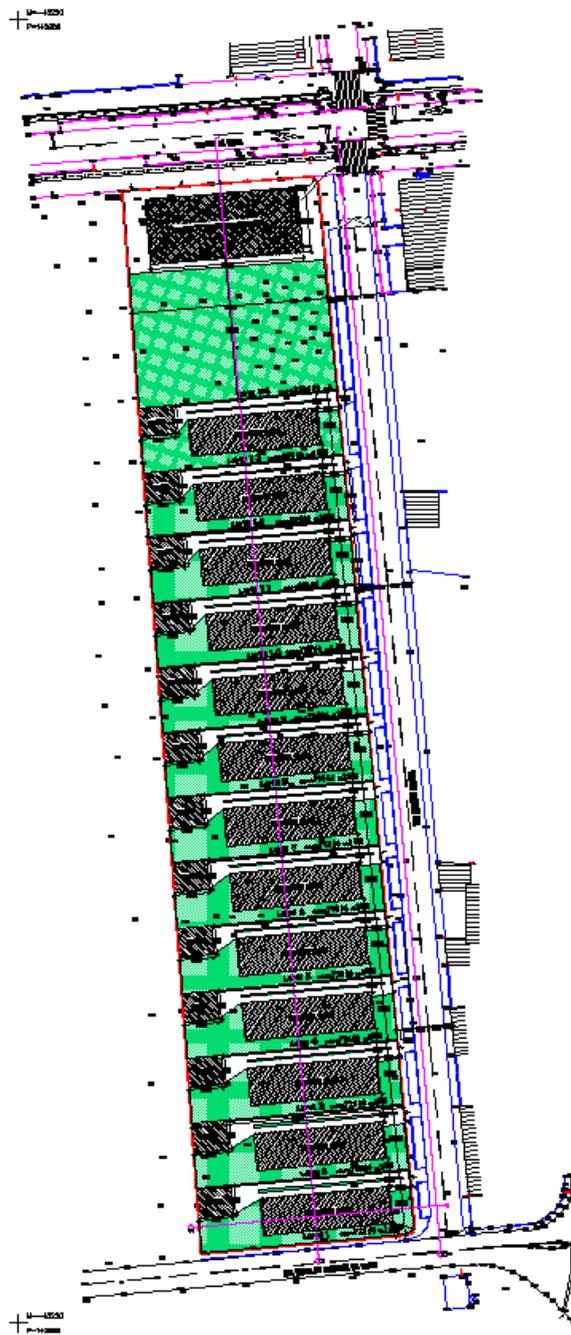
Planta Síntese (Processo n.º 486/2023)
